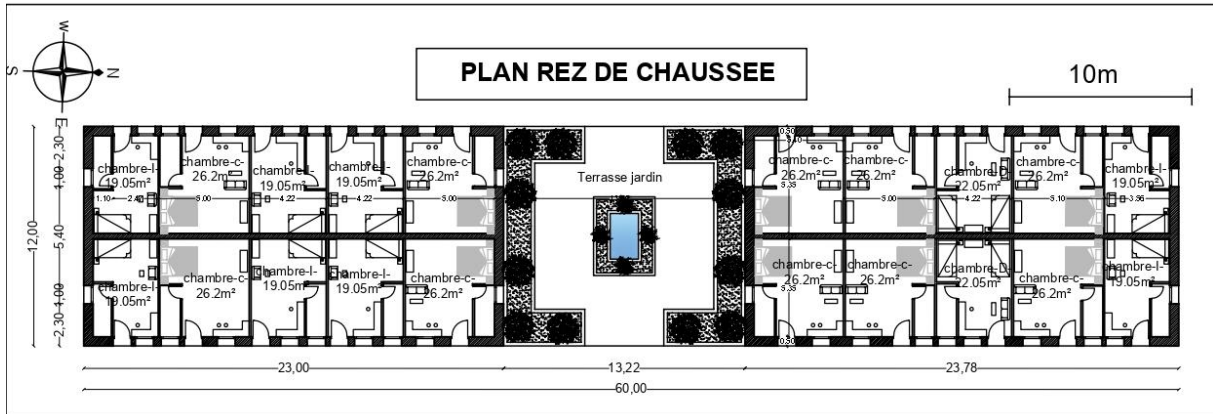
plan RDC de bloc E (hébergement).source : auteurs
